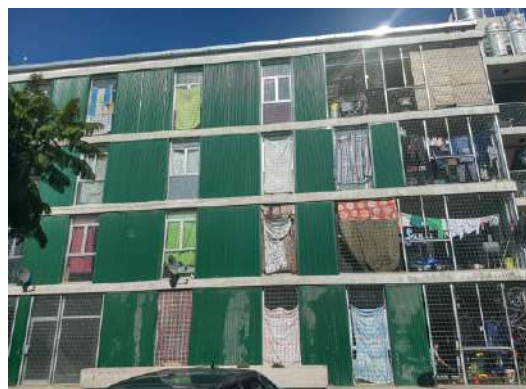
Detalles de las fachadas y los elementos que cubren balcones y vanos. Se recurre a todo tipo de materiales, desde cartones, cortinas, y hasta una pileta de natación como en la primera imagen.
